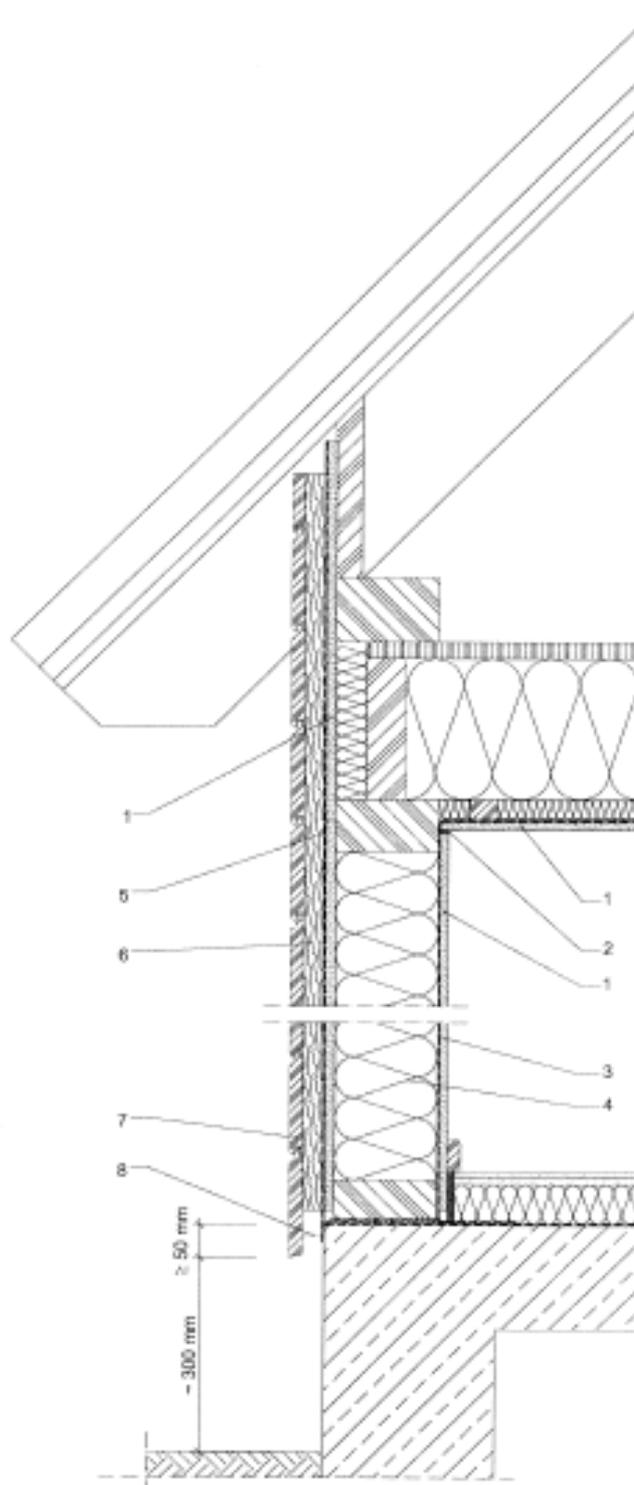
Mur extérieur bardage rapporté avec isolation
